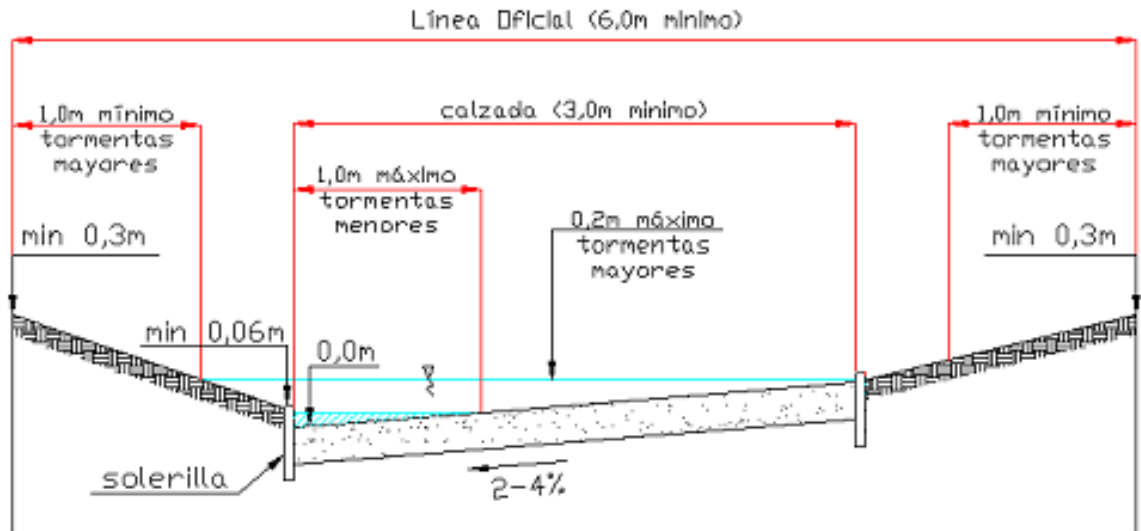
Ejemplo de sección transversal alternativa en Pasajes.
